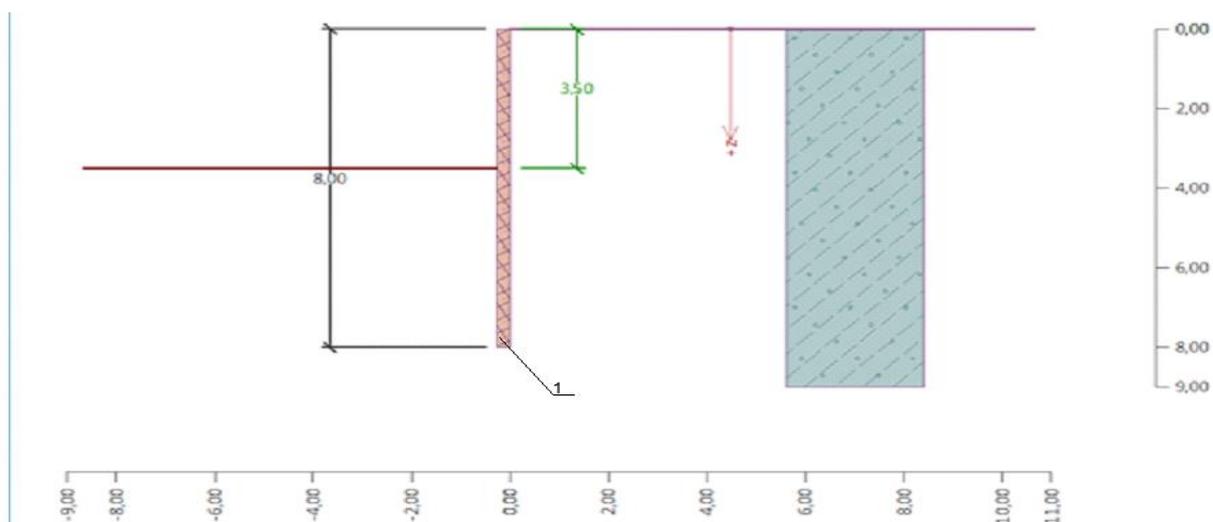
Расчетная схема конструкции шпунтовой подпорной стенки
